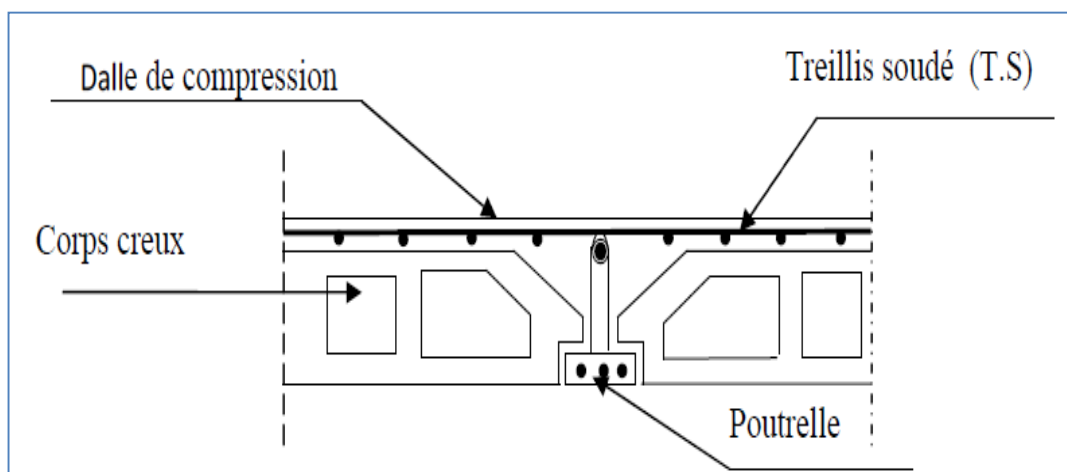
Coupe verticale sur un plancher en corps creux.
